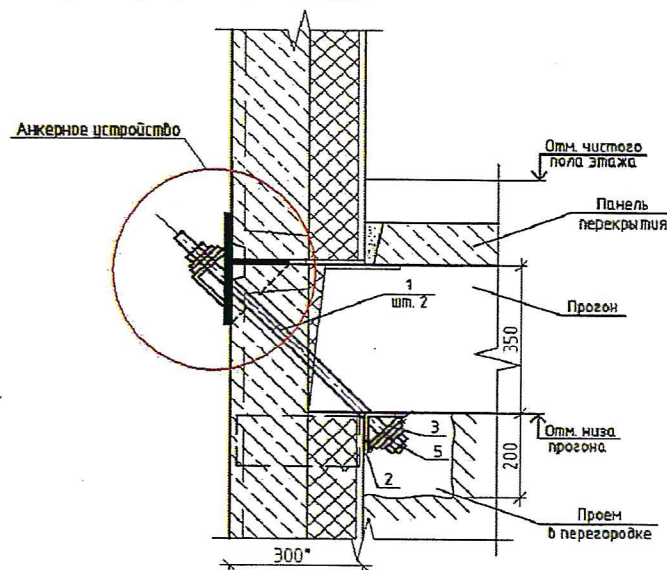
Схема анкерного устройства – поэтажный узел опирания прогона
